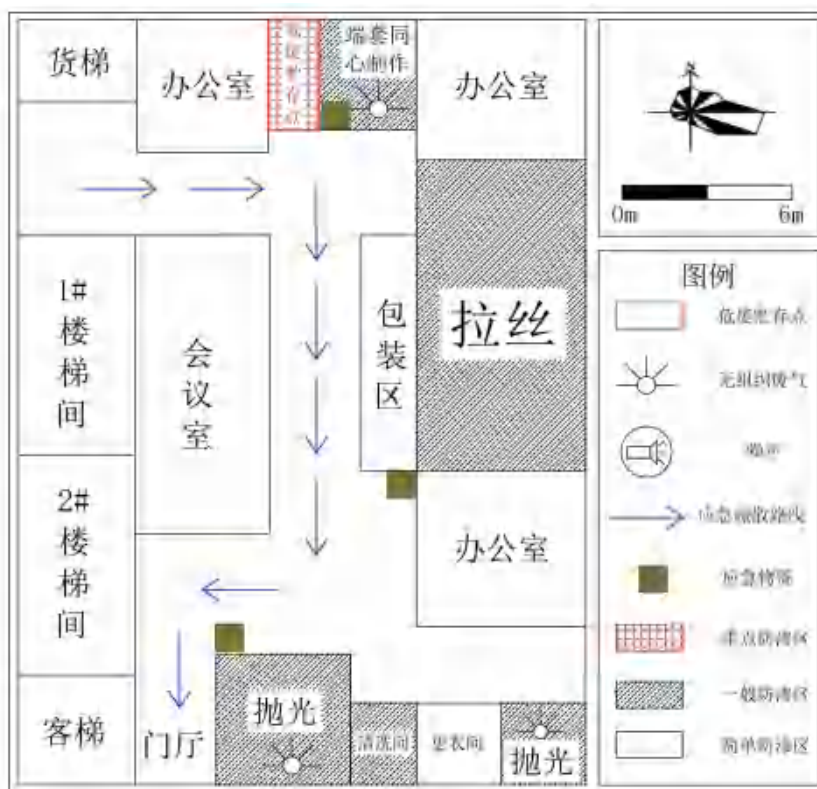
车间一层平面布置图（与环评一致，未发生变化）
